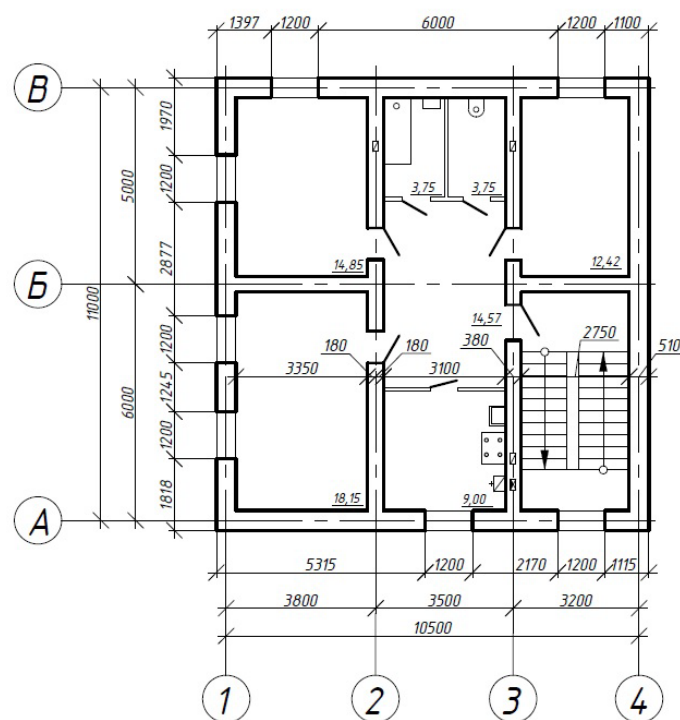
План второго этажа жилого здания, выполненный обучающимся
